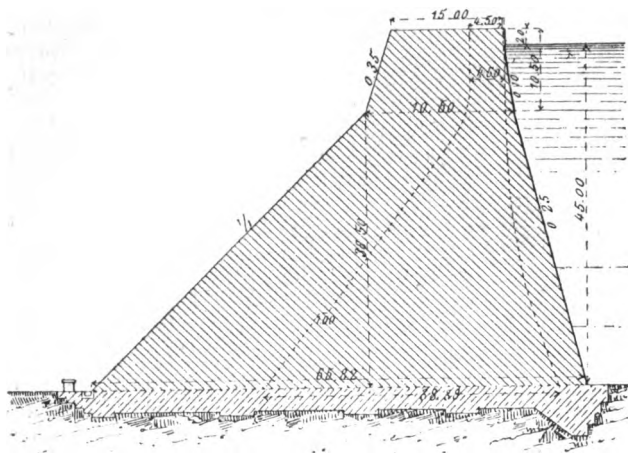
Profil du barrage de la Gileppe (Belgique).
